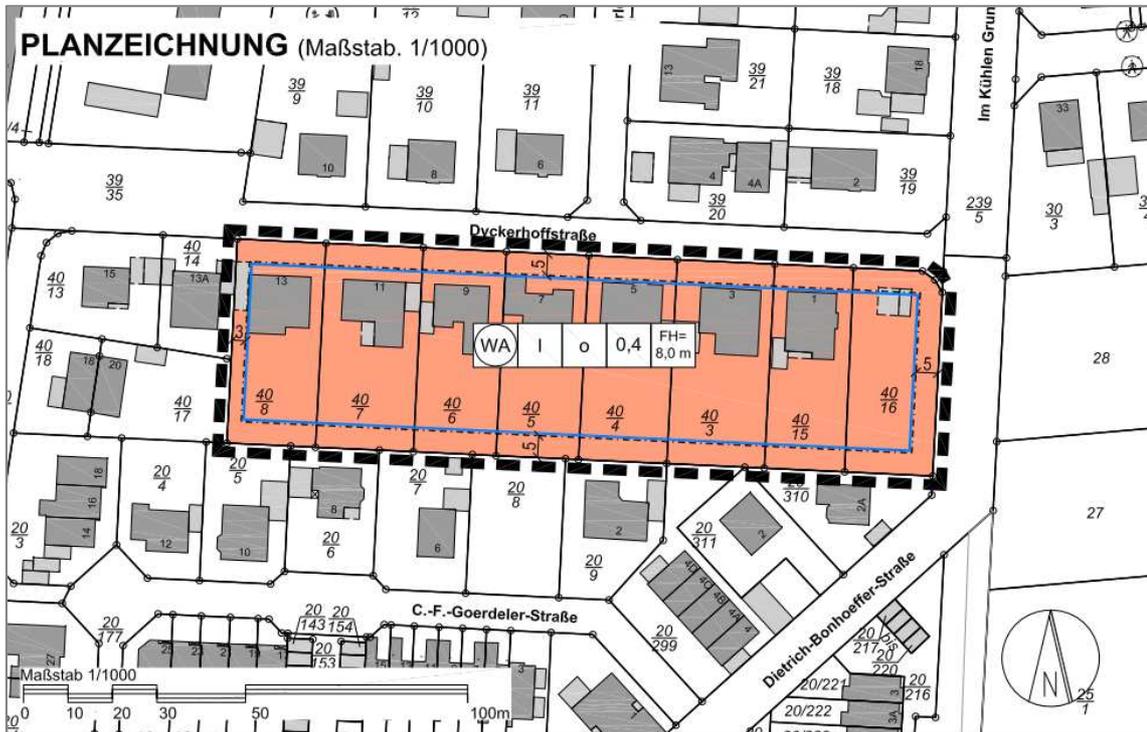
Planzeichnung 9. Änderung Bebauungsplan Nr. 104 (Quelle: Plan Hc, Stand: Feb. 2021).
